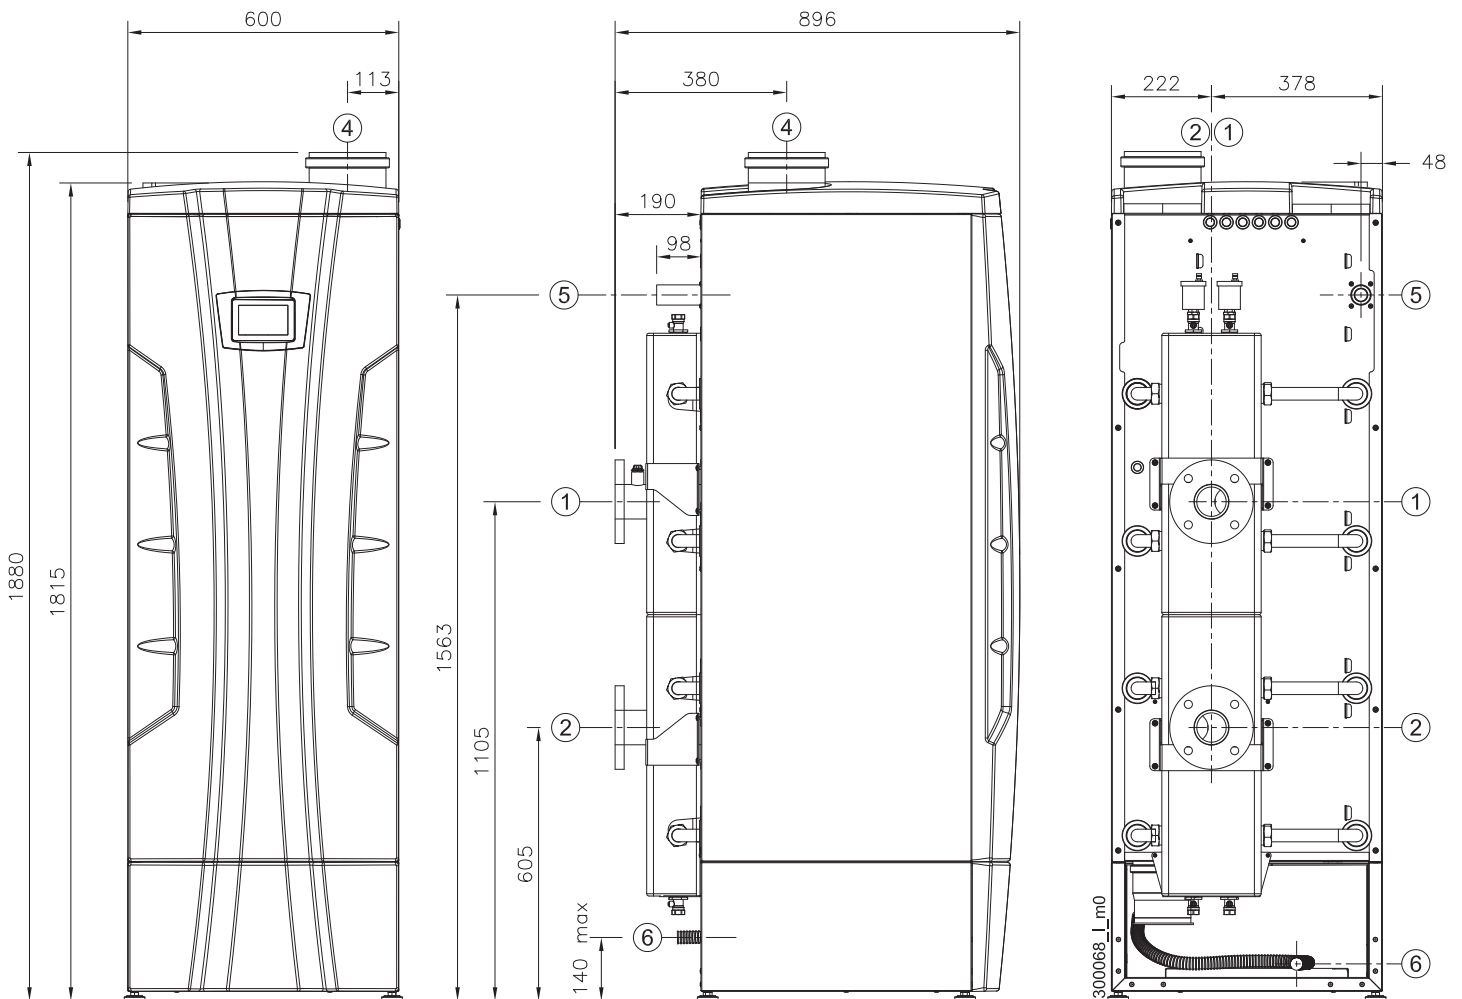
Dimensioni modelli 180-210-280 (riferimenti in tabella Figura 6-9)
